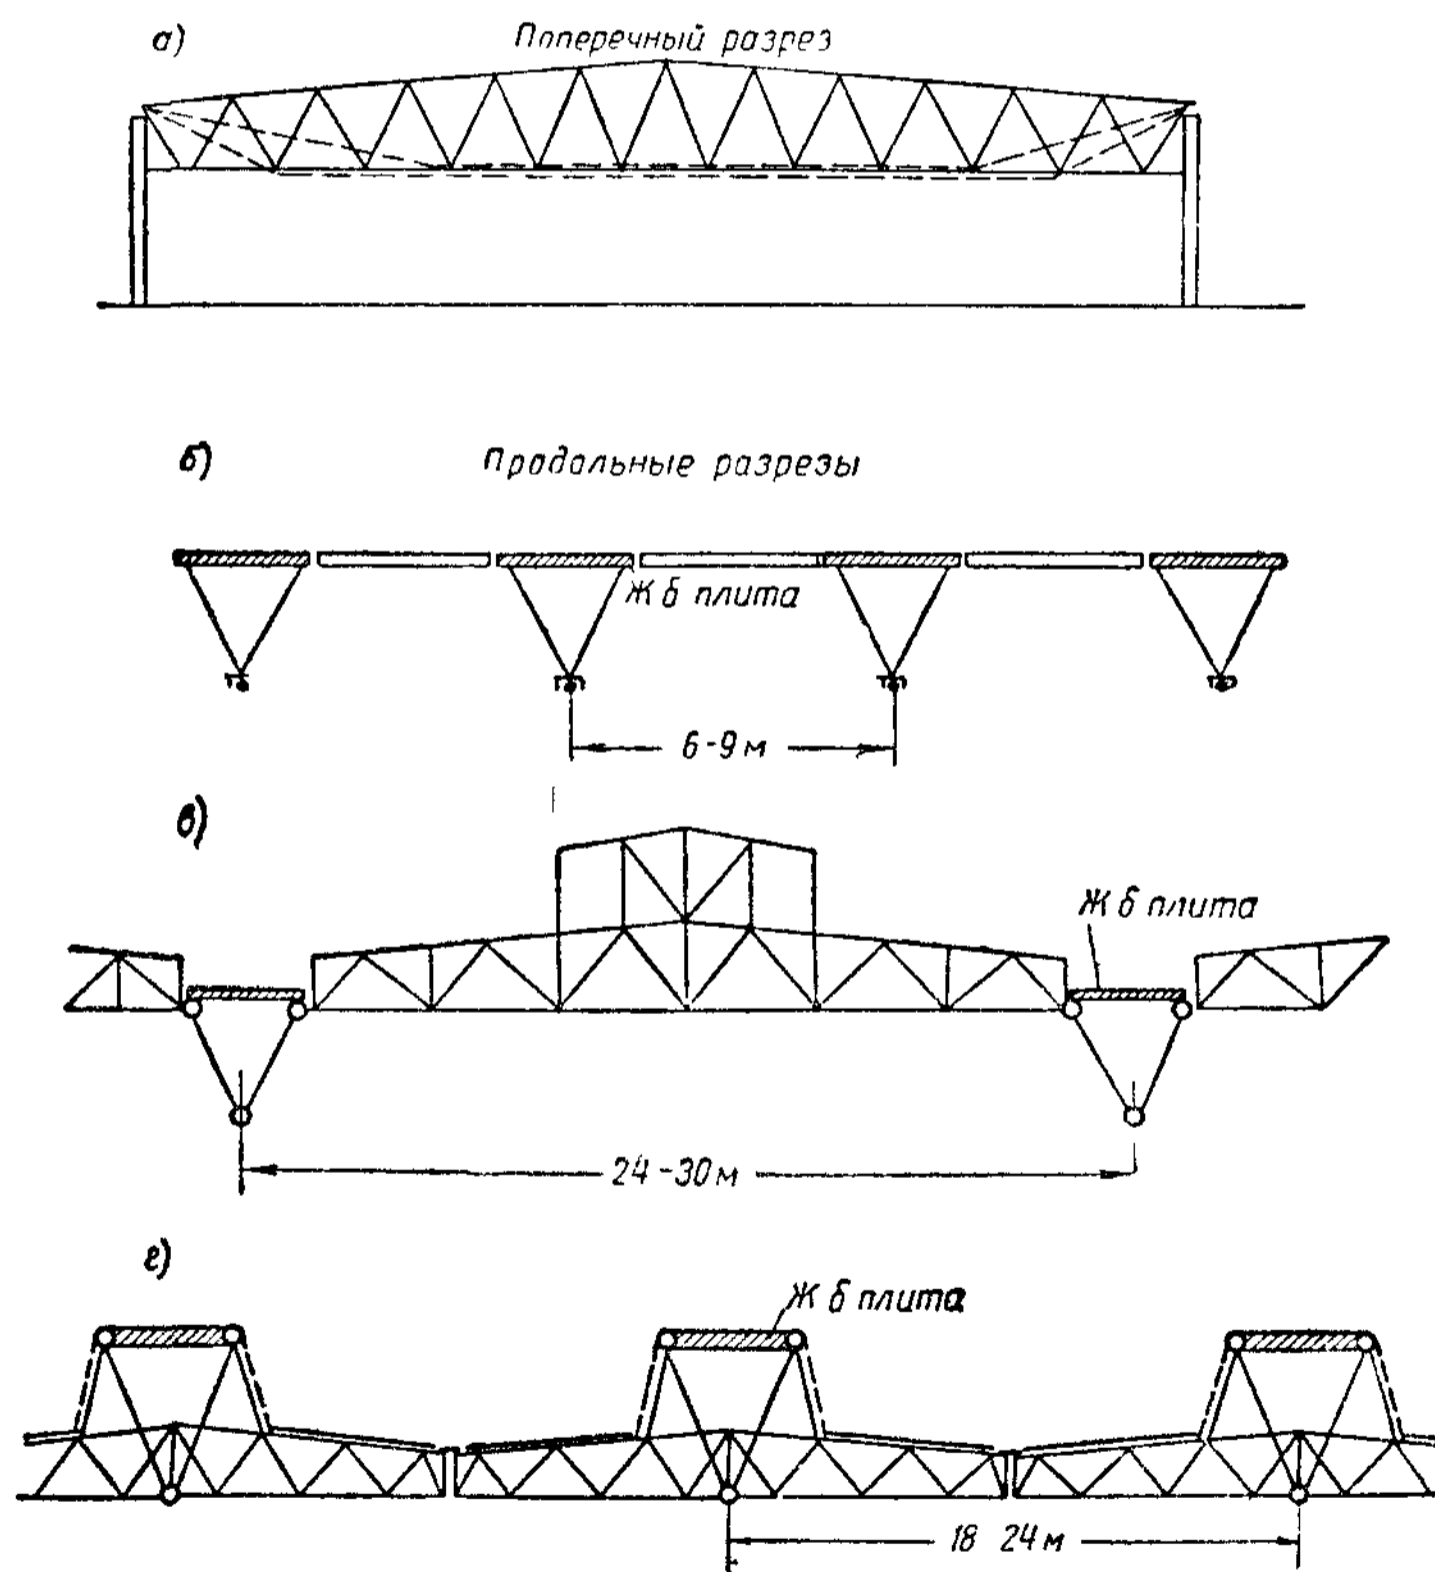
Перекрытия с трехгранными балочными фермами
